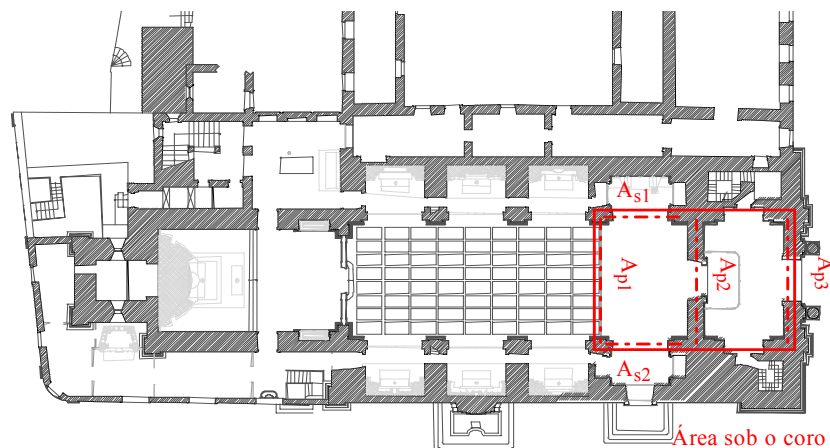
Planta do Piso 0 da Igreja do Pópulo (DGEMN)
